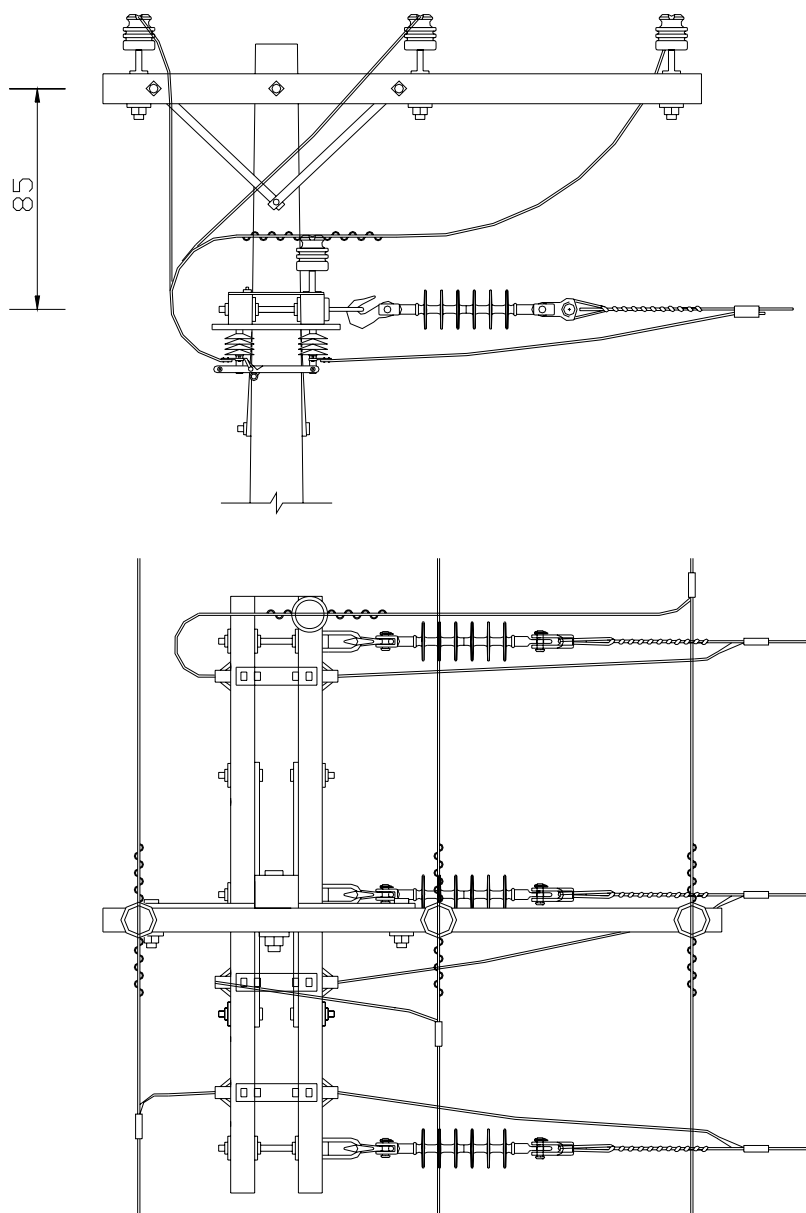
Estrutura M1-N3 (derivação chave faca)
